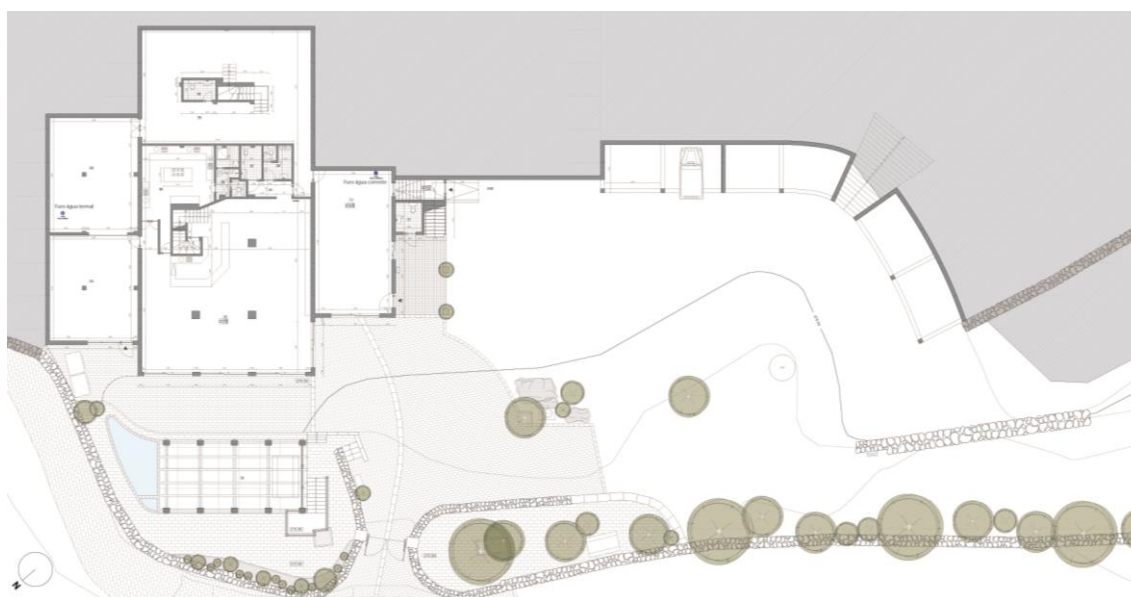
Planta de levantamento de pousada rural de piso -1
